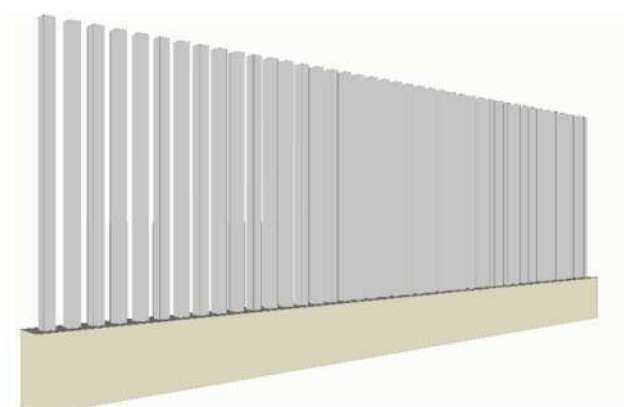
Vista prospettica della recinzione della SSE utente di trasformazione
